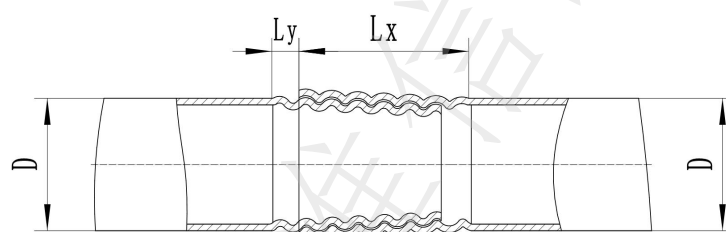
圆锥螺纹连接结构形式（装配尺寸图）
